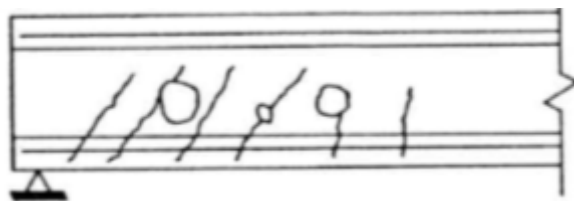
Fissuras causadas pelo esmagamento do concreto na viga. Fonte: (CARVALHO, 2008).
